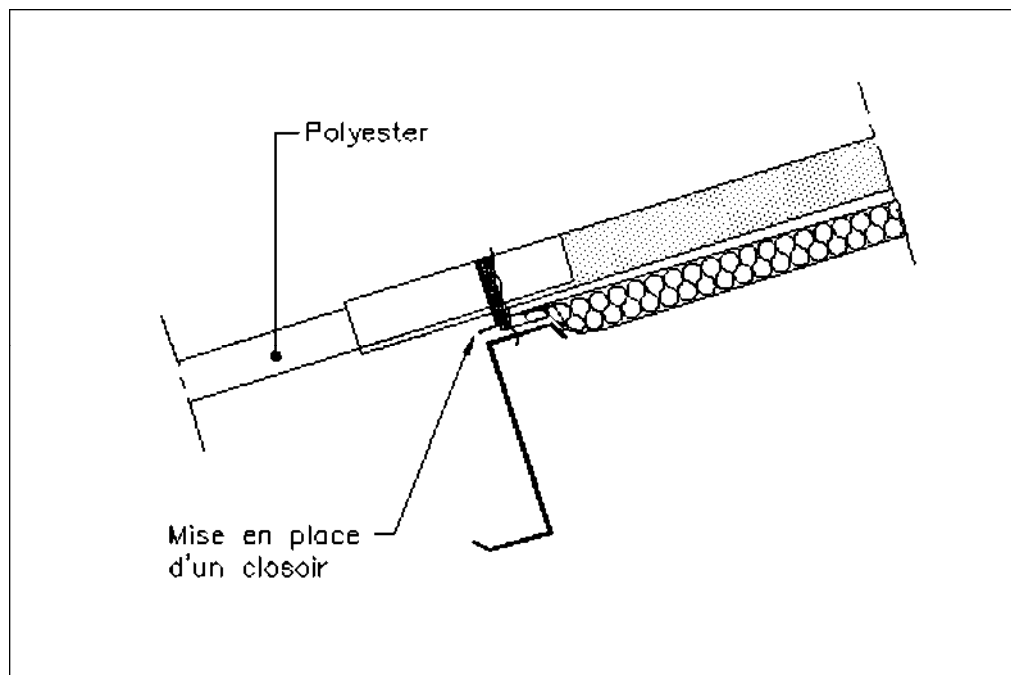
Isolation sur panne - Feutre isolant déroulé sur pannes Recouvrement longitudinal sur parties éclairantes (exemples)/Variante 1 - Enlever l'isolation du pare-vapeur sur 100 mm environ - coller ou rabattre avec cornière métallique sous la plaque aluminium
